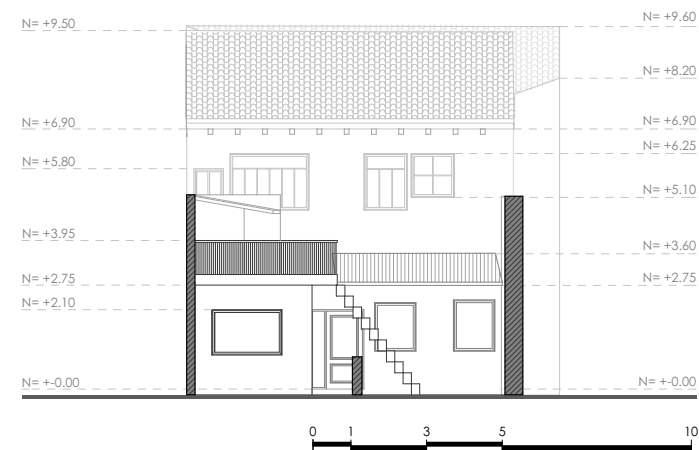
Elevación norte | Caso de estudio 2, Vivienda Berrezueta.
